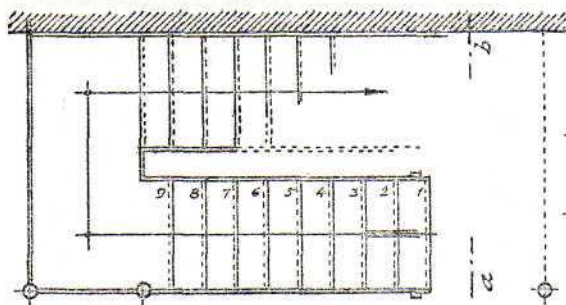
PLANTA DE UMA ESCADA DE LANÇOS
